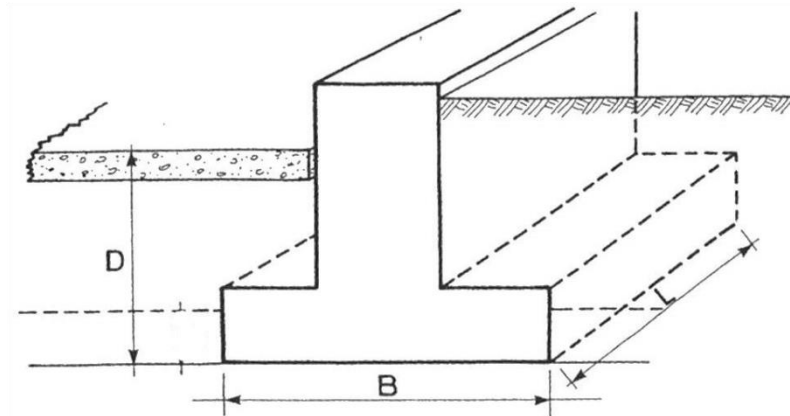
Définition de la hauteur d'encastrement géométrique d'une semelle.
